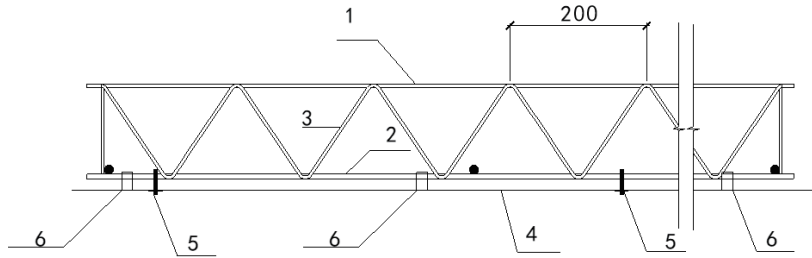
(a) 钢桁架纵向立面图 (h—桁架高度)
